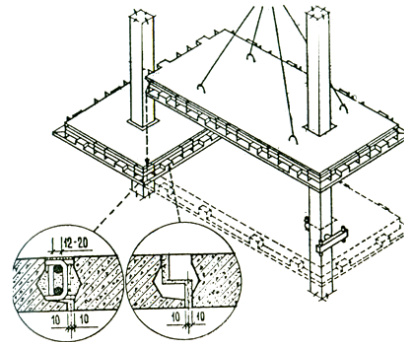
Монтаж плит безбалочного перекрытия с монолитными стыками модификации КУБ – 2,5
